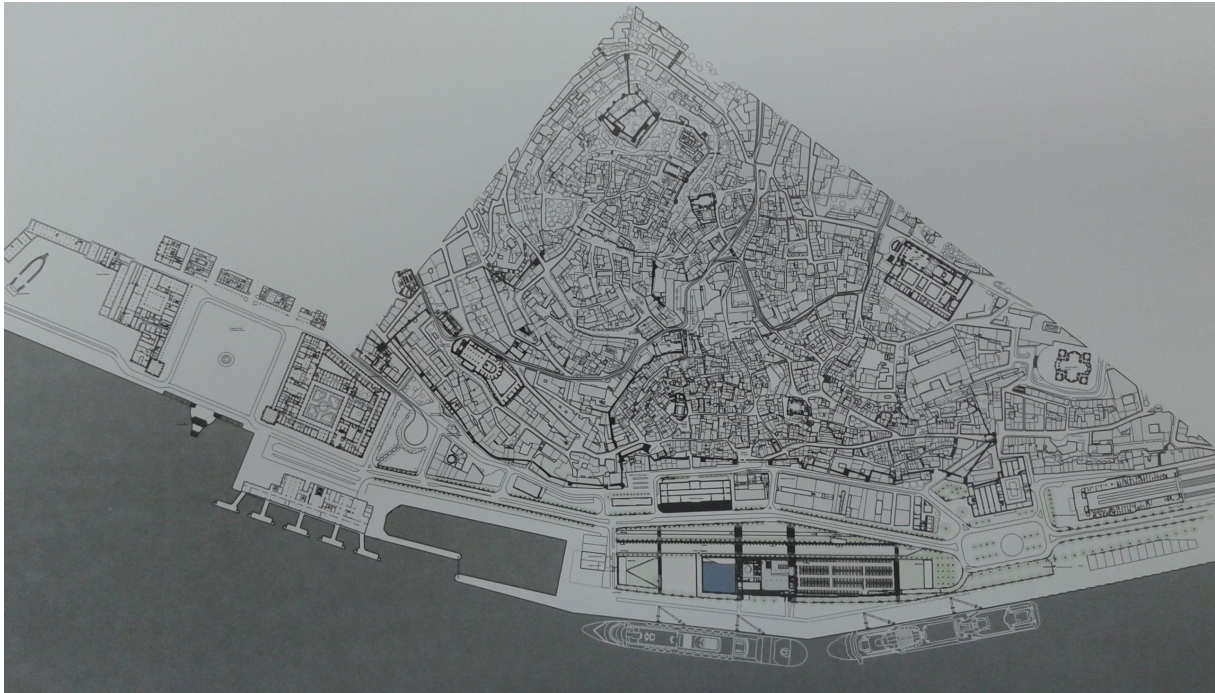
J.L. Carrilho da Graça, planta do Terminal do Cruzeiro
